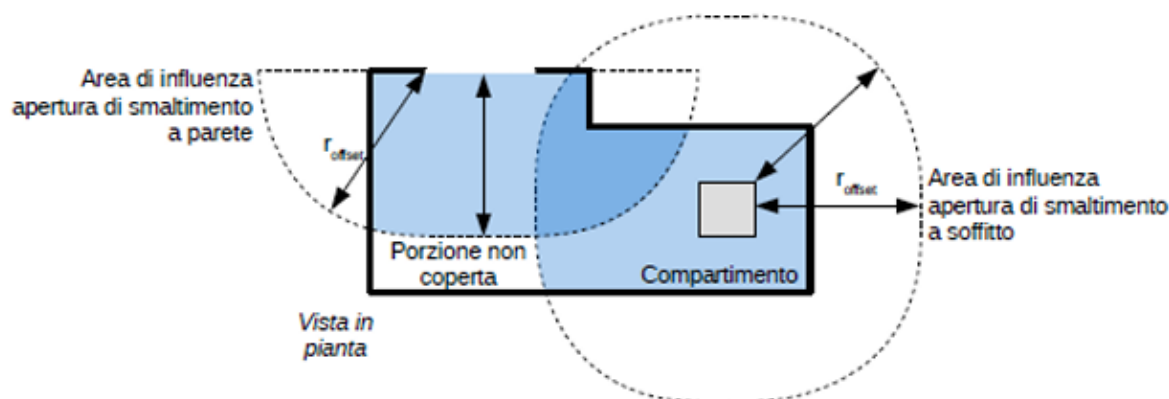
Verifica dell'uniforme distribuzione in pianta delle aperture di smaltimento
